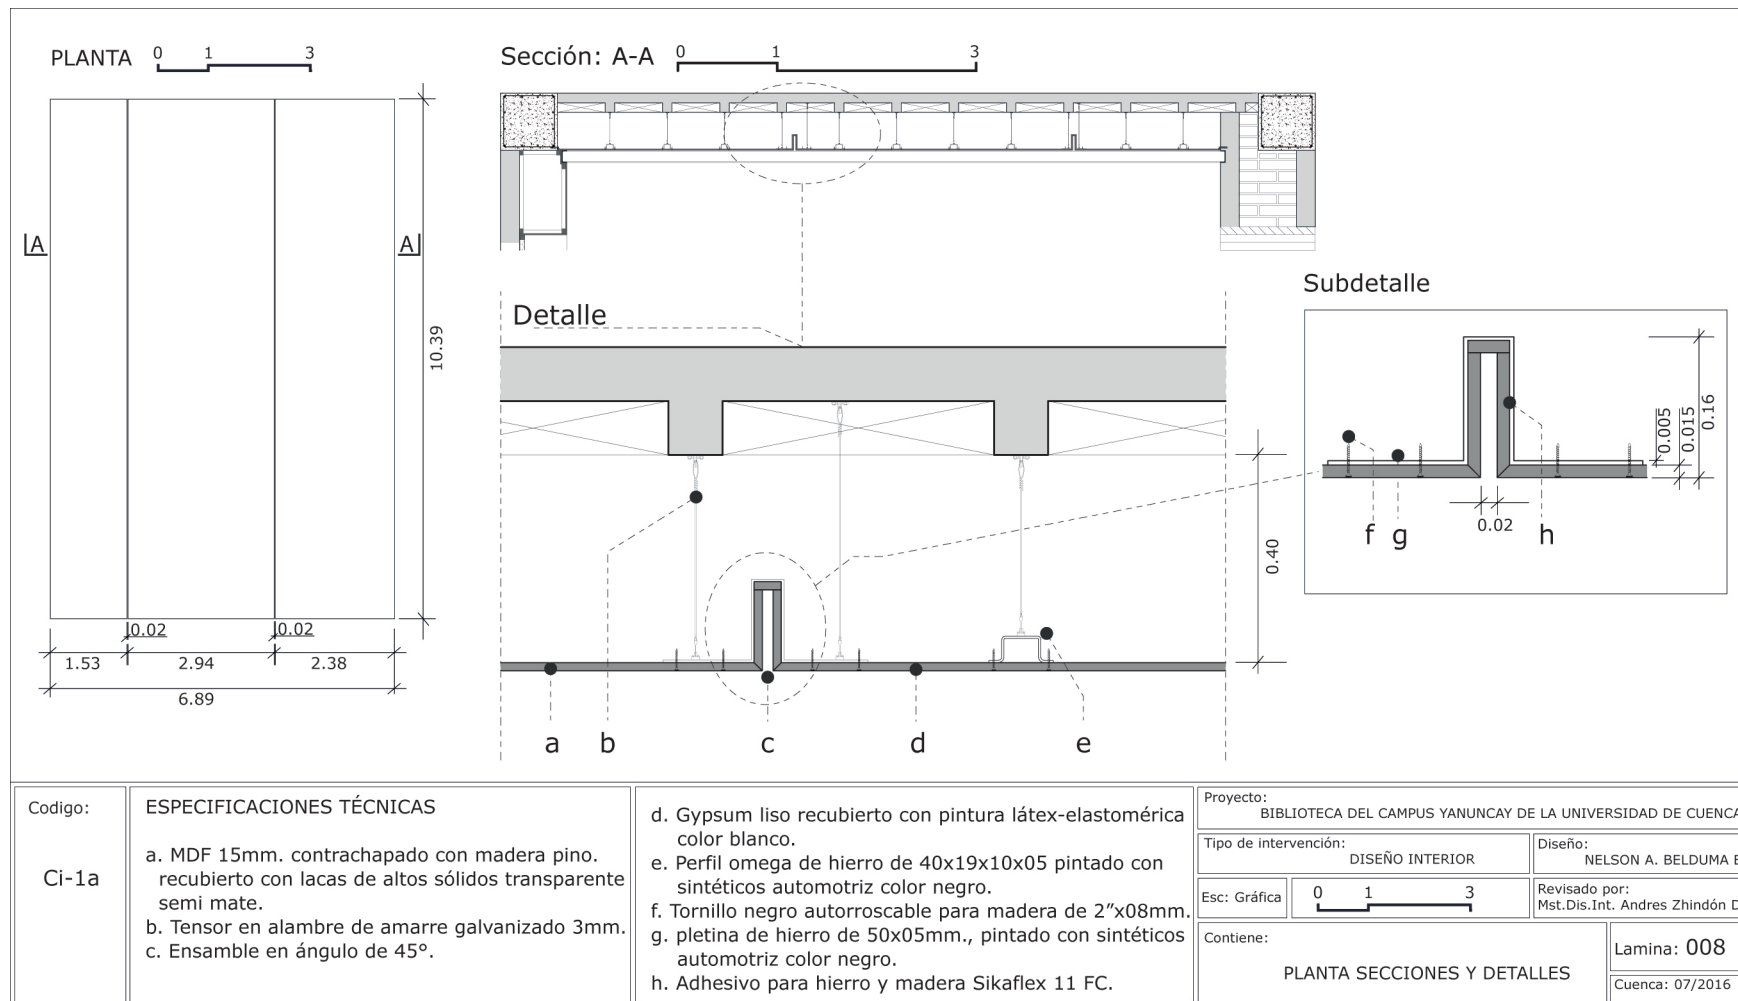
Planta, secciones y detalles. Sala de lectura. Ci-1a.
